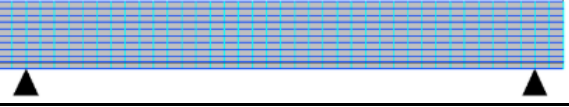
Betonarme kiriş elemanın geometrisi ve yükleme durumu
